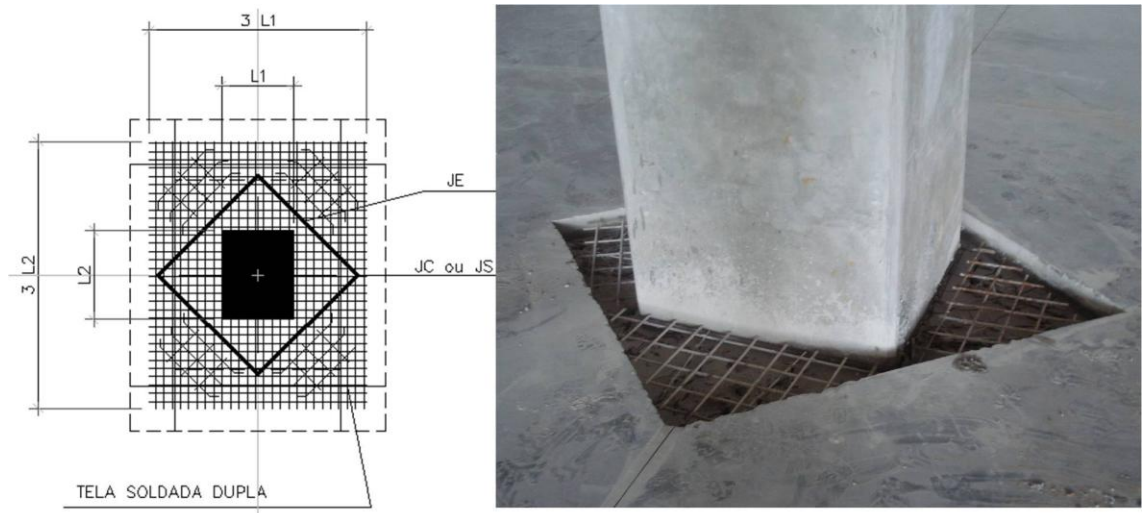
DETALHE ARMADURA DE REFORÇO
